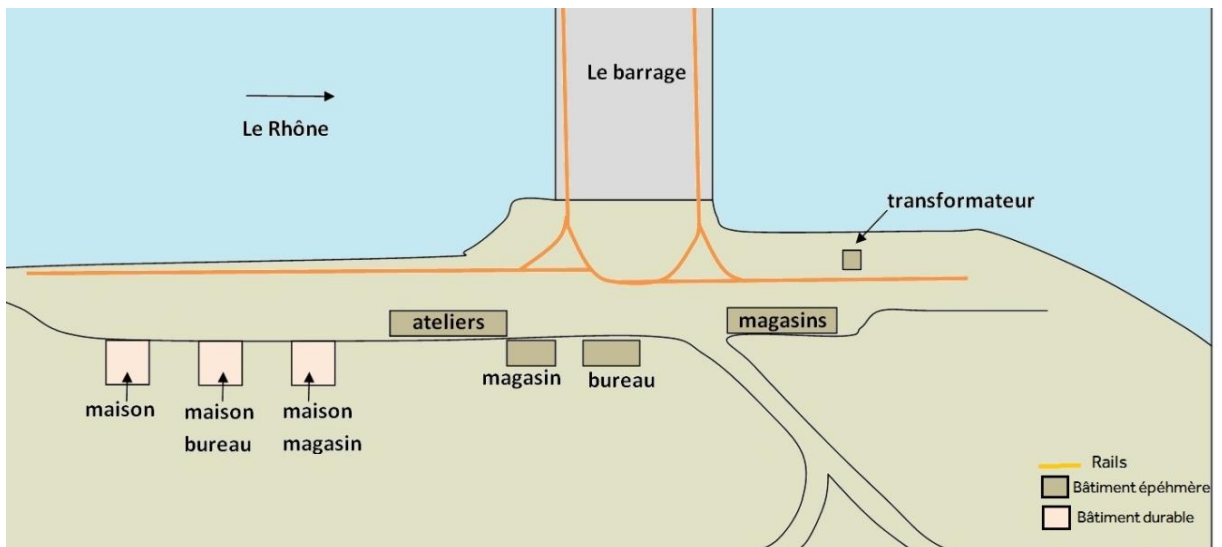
Schéma d'ensemble du chantier de construction du barrage de Jons (source : A.D.R. 156 J 131)
